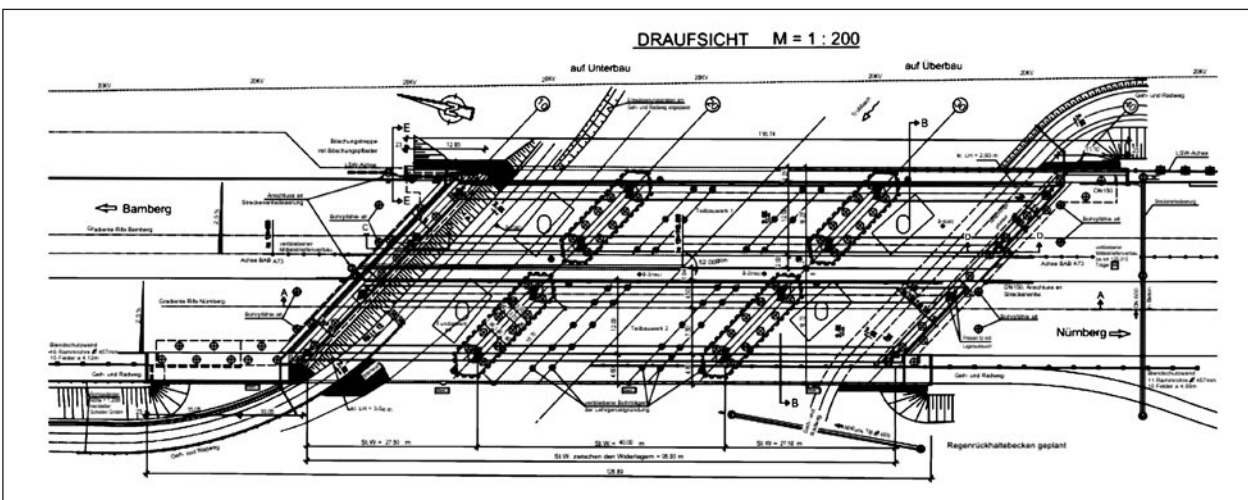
Draufsicht Trubbachbrücke mit Nordpfeilausrichtung
